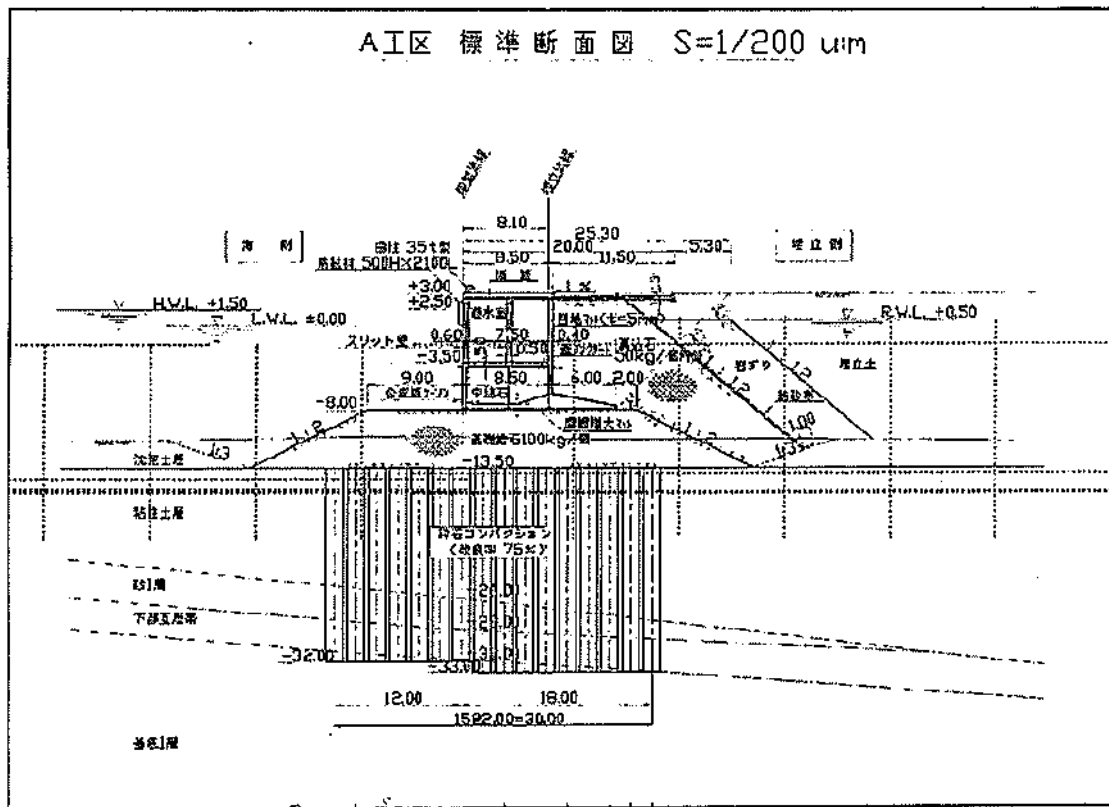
須賀地区岸壁（耐震強化）(-7.5m)の標準断面図
